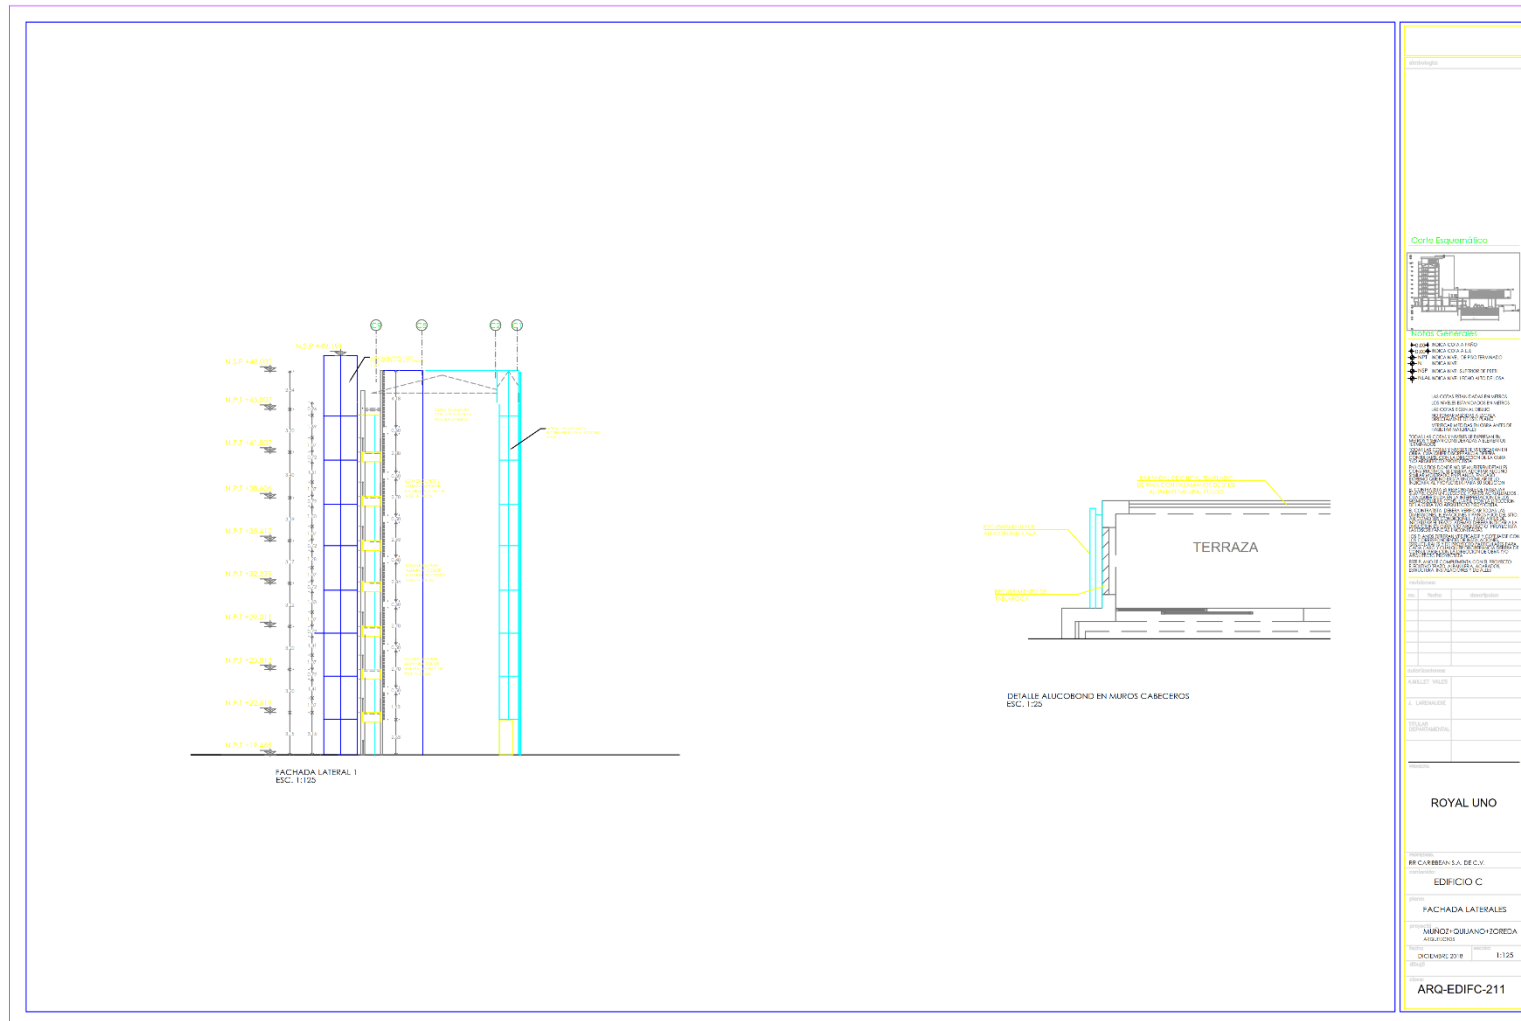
Edificio C, Fachada lateral. Anexo C-7.
